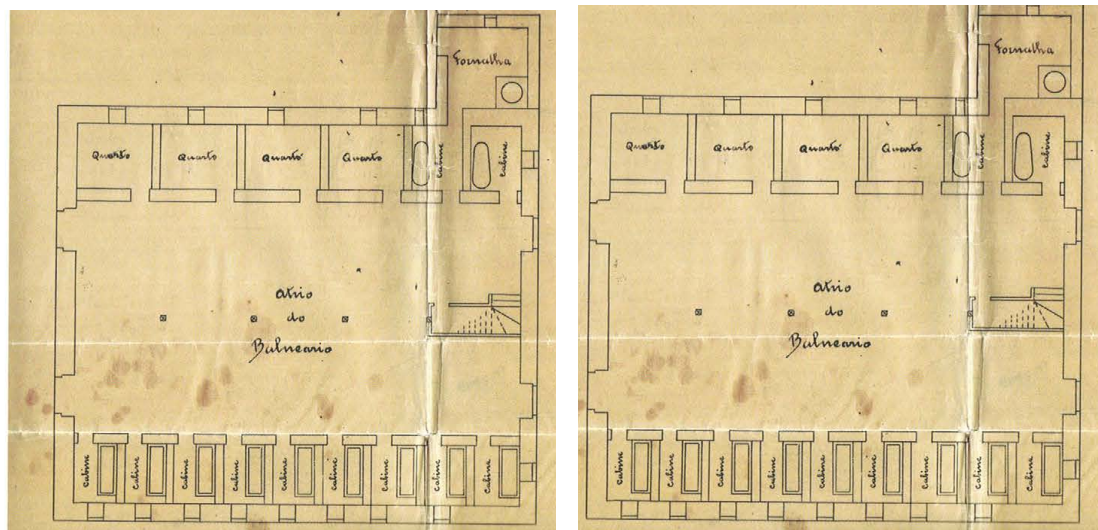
a) Banhos de Azenha, Planta Rés-do-Chão; b) Banhos de Azenha, Planta do 1º Andar (Mangorrinha e Pinto, 2009)
